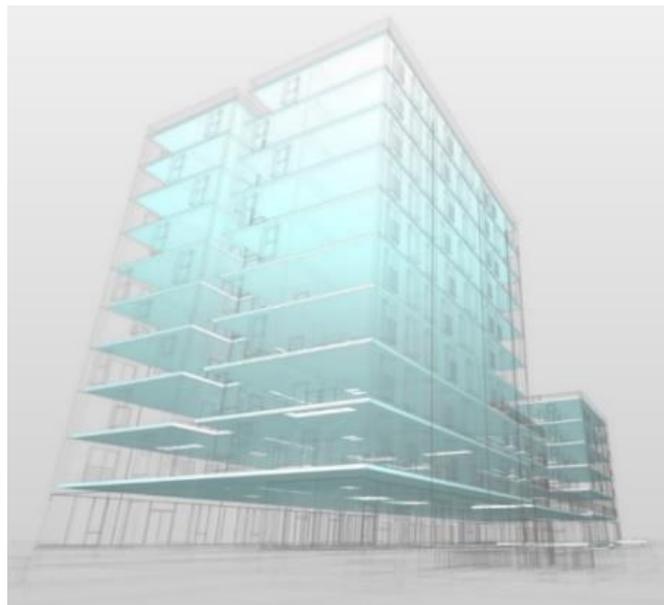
Deckenelemente in Fallstudie 1 ¹⁶⁰
